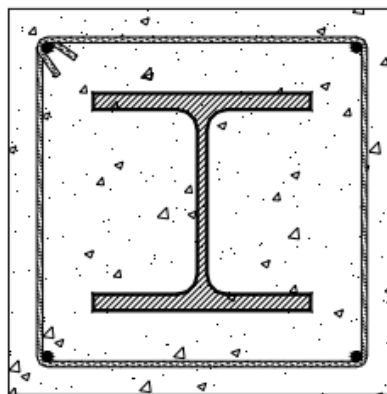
Secção de pilar metálico envolto em betão armado. [42]
